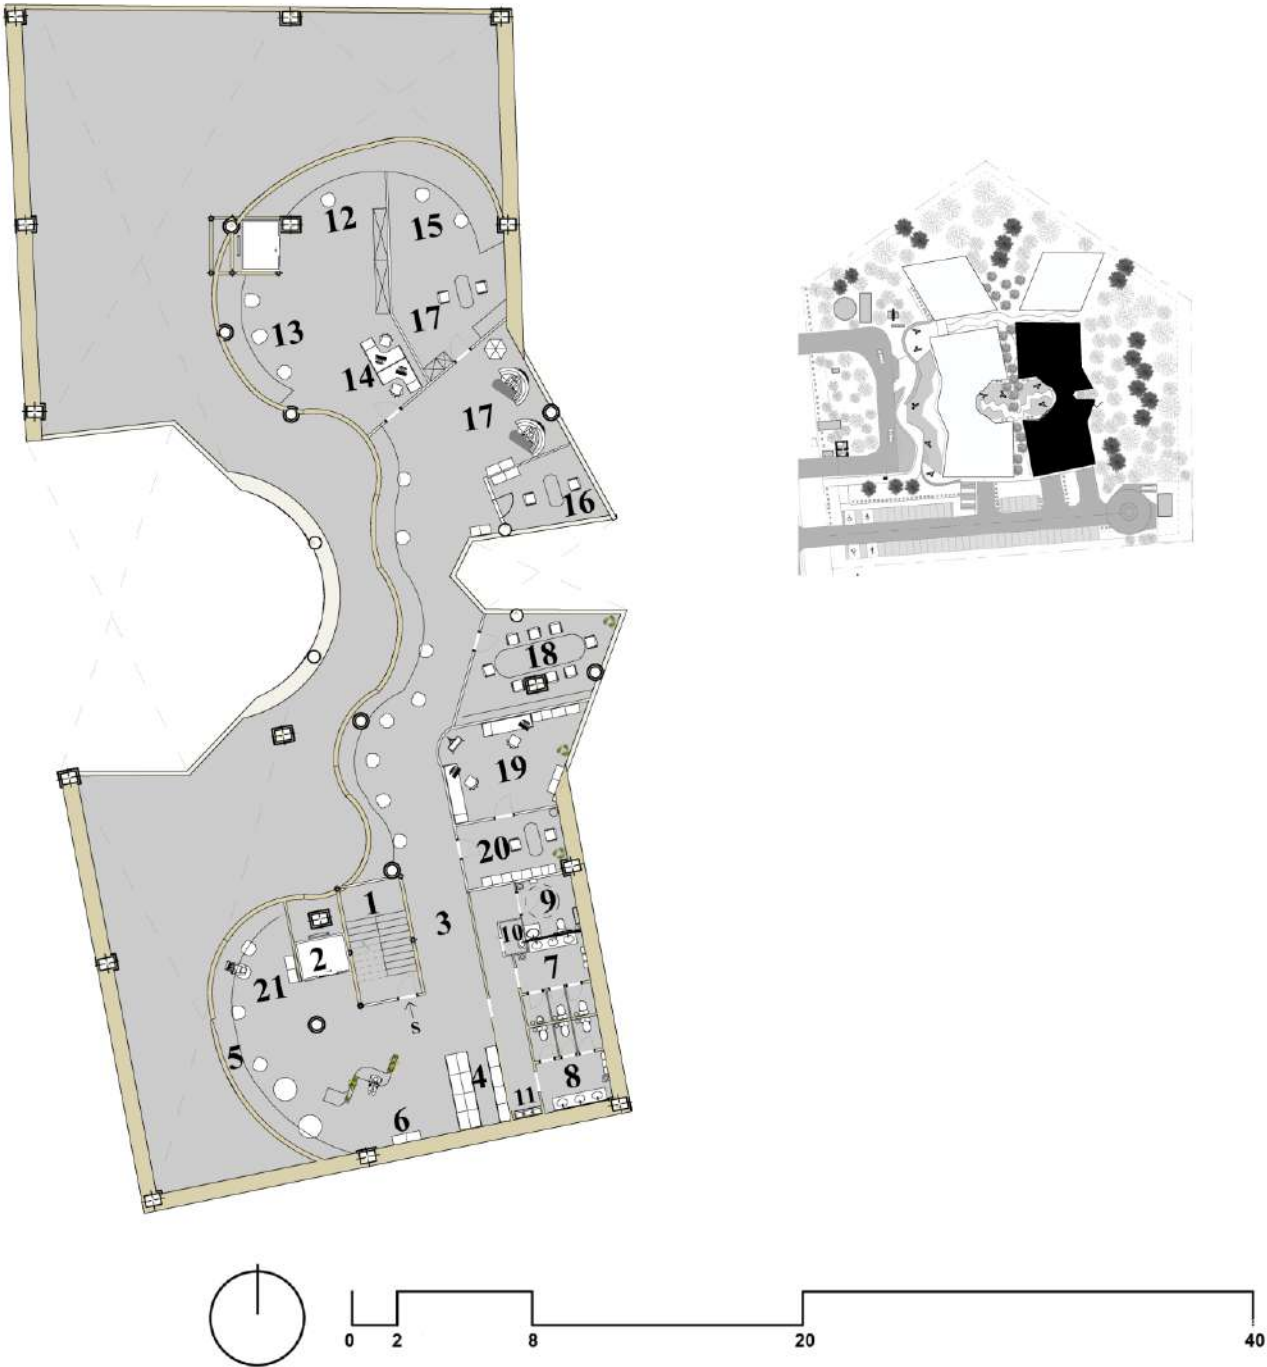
Planta Arquitectónica de nivel 01, edificio B, elaboración propia, 2024.
